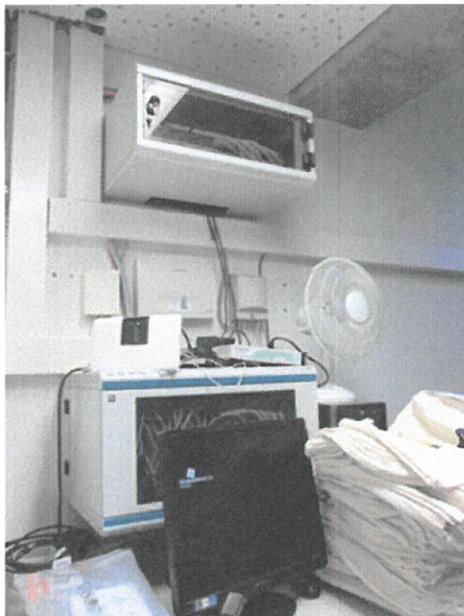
, vorhandene EDV-Installationen im Hausanschlussraum Hauptgebäude
